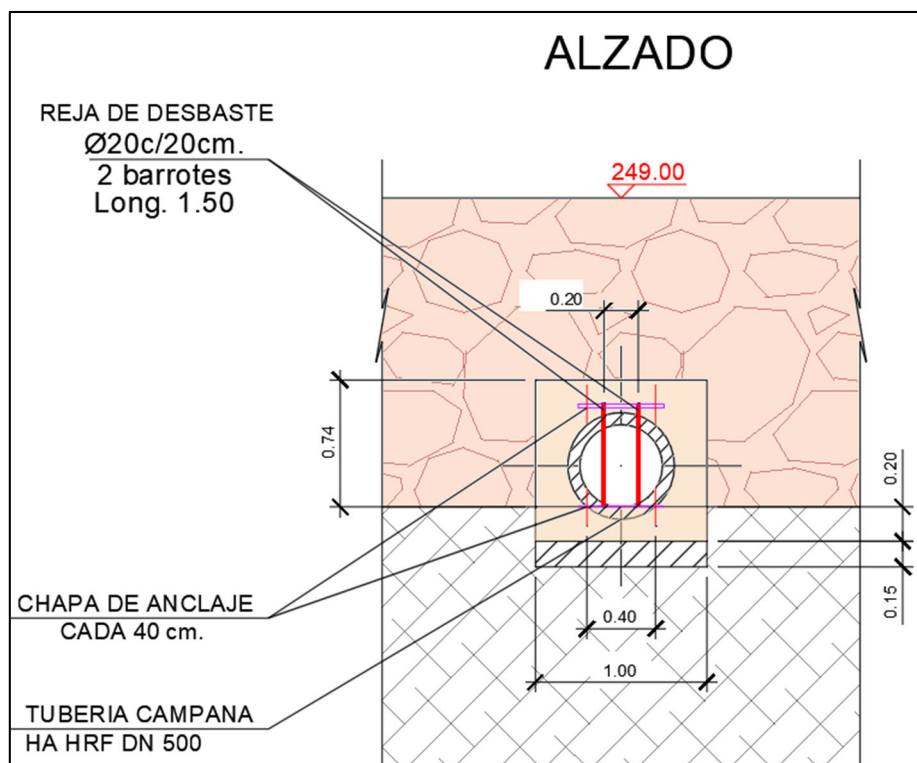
Alzado de la reja de desbaste en la embocadura de la conducción de DN500.
